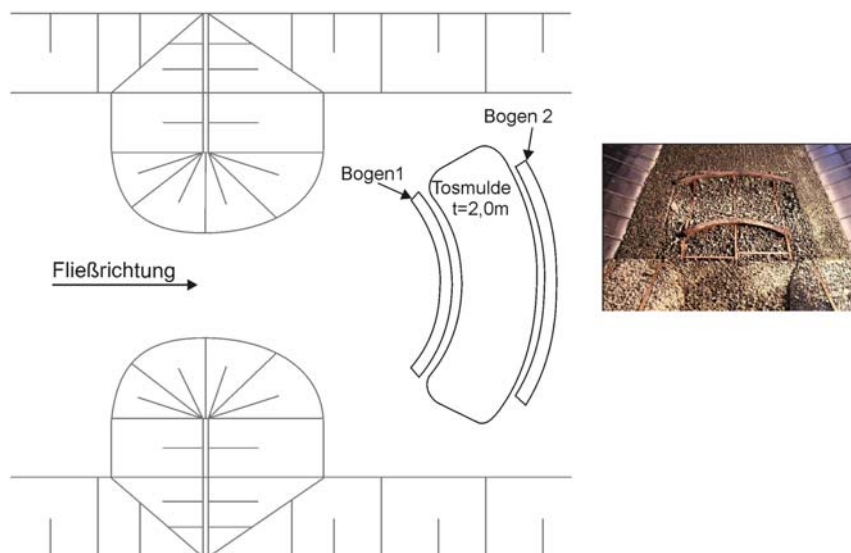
Verwendete Einbauten bei der Detailuntersuchung der V-Rampe bei km 13,8
